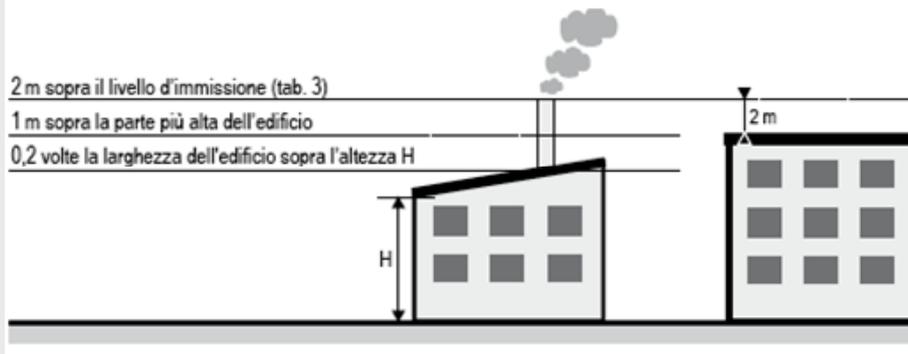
> Secondo caso (impianto a combustione di grandi dimensioni)
